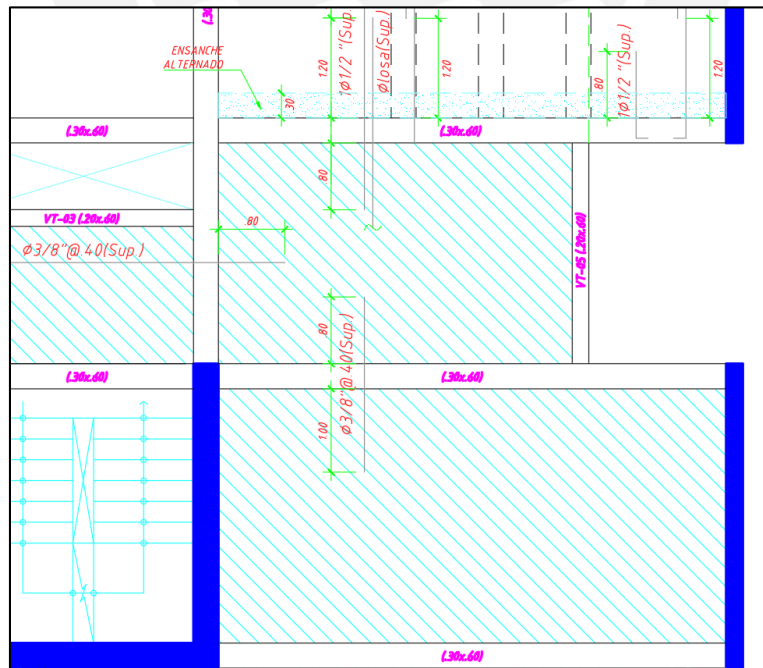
Diseño de losa maciza en plano de encofrados.
